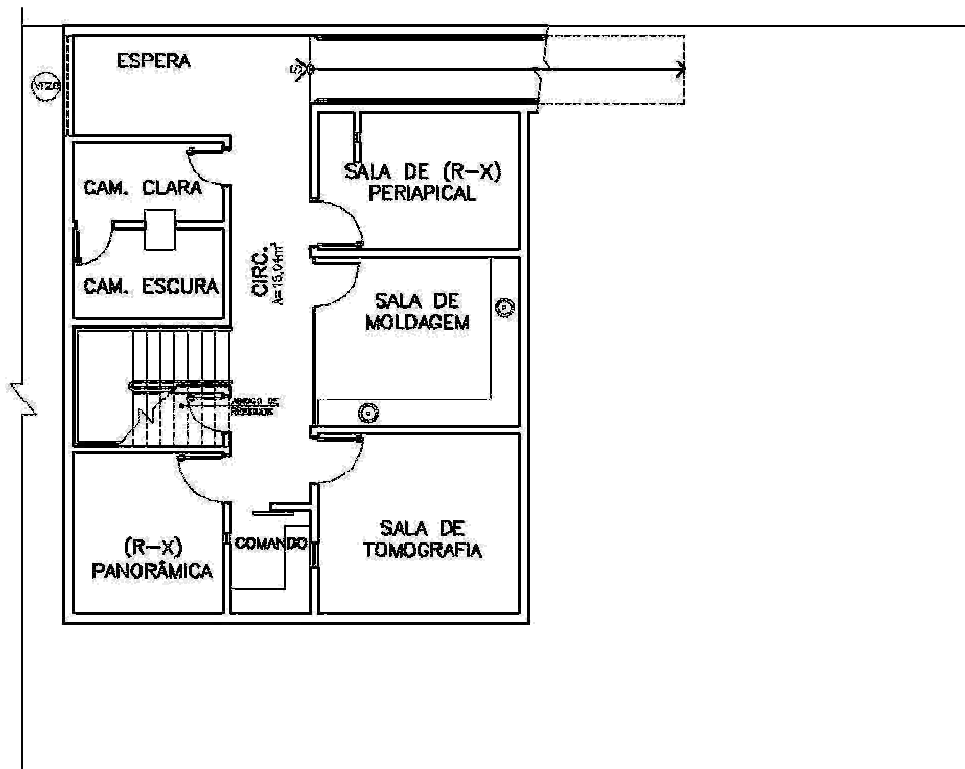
Planta baixa do pavimento subsolo – Obra C
